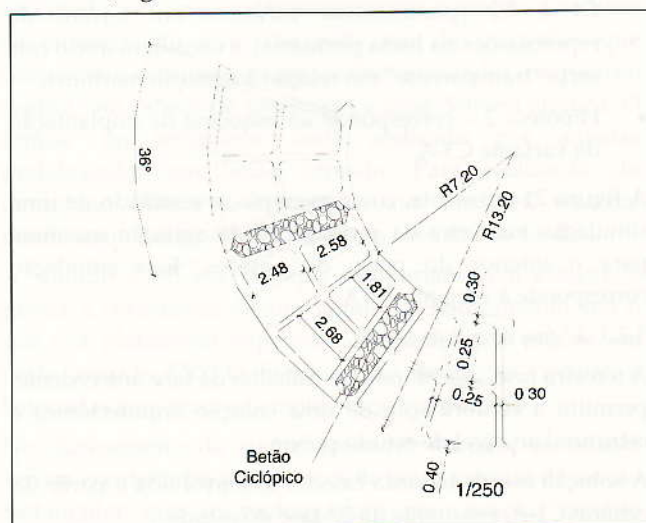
Pormenor da ligação entre aduelas, IHRH (2006).
